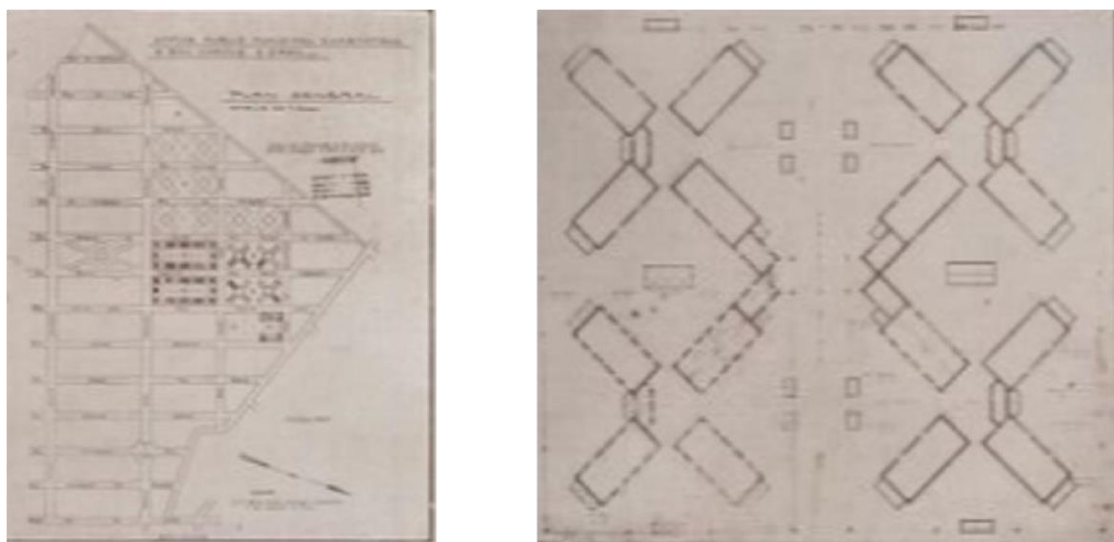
plan d'ensemble et plan de la 2ème tranche de la cité Maraval à Oran. Source : Les chantiers nord-africains, 1929, p.581
